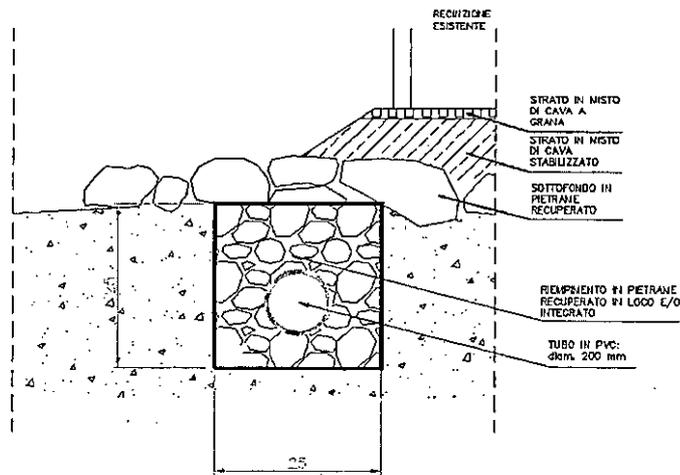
Dettaglio della sezione tipo del cavidotto di servizio
